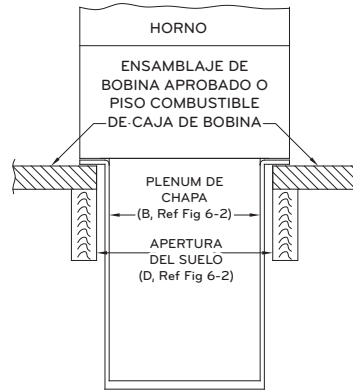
Horno, plenum y conjunto de bobinas a caja de bobinas instalada sobre un suelo combustible
